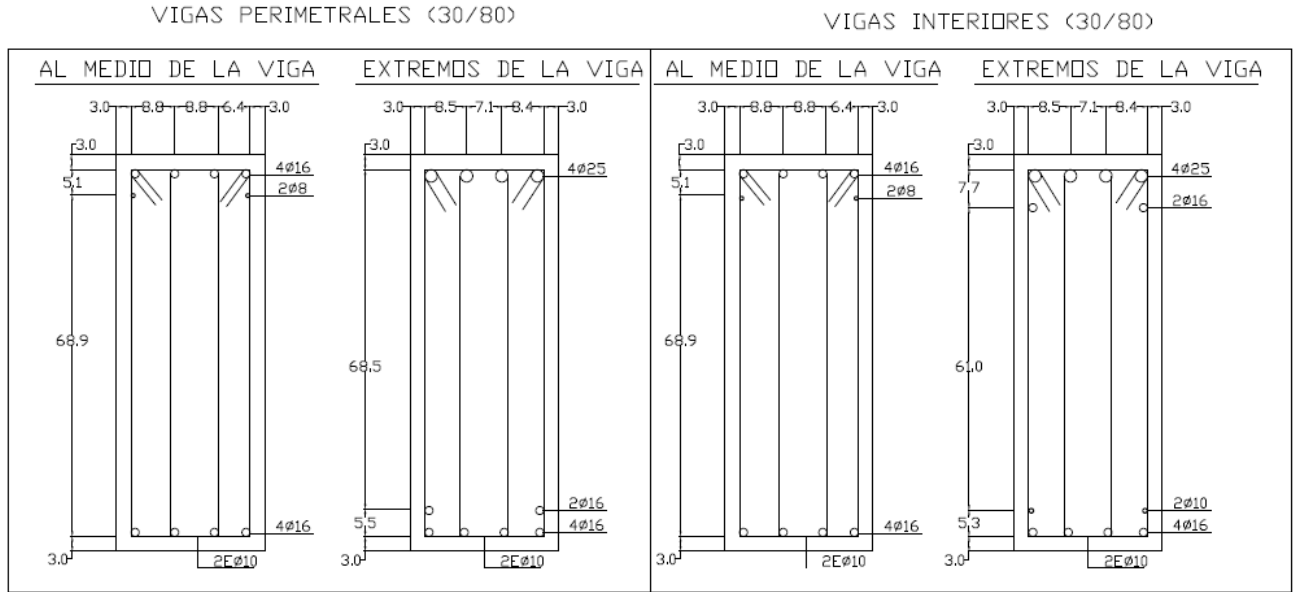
Sección transversal de las vigas del piso 1 de la estructura aislada
